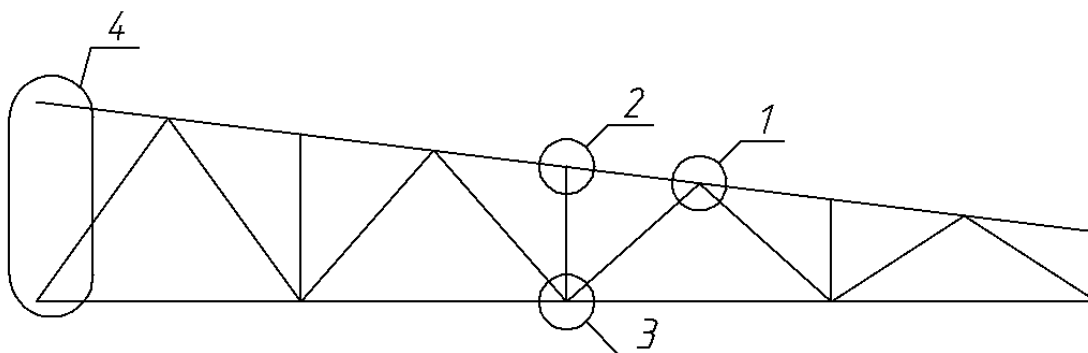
Схема расположения узлов к расчету и конструированию узлов фермы
